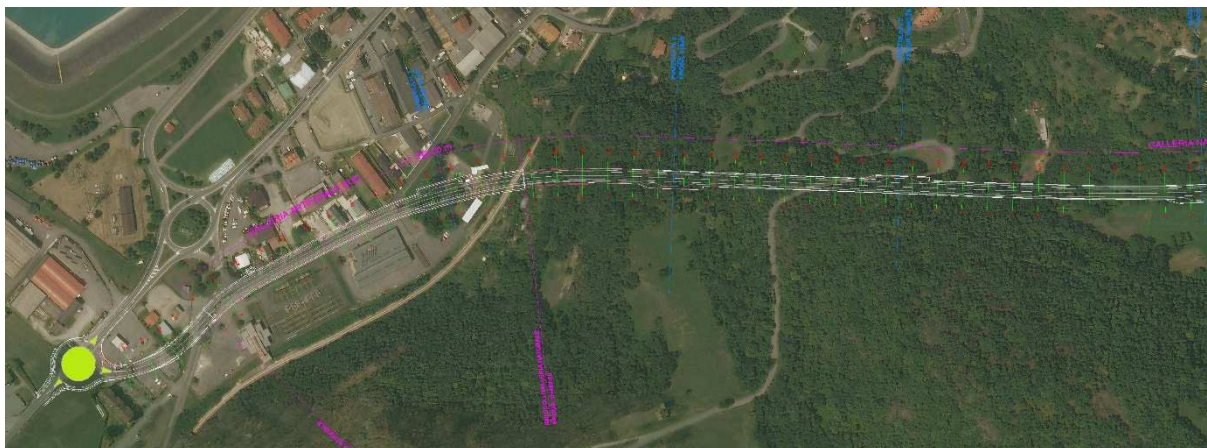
Schema planimetrico tracciato - Tratto Sud
